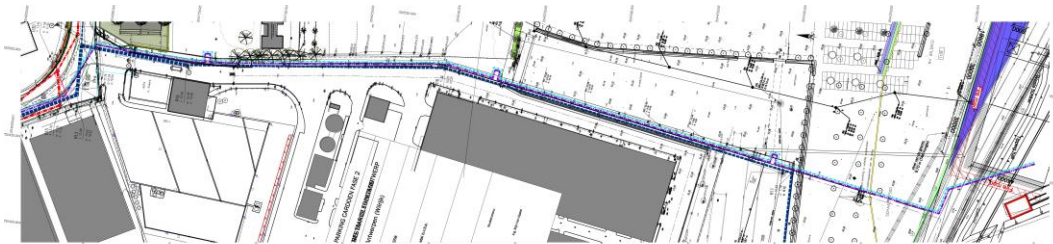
Plantekening van de riolering en het warmtenet in het plangebied (deel 1). Bron: opdrachtgever.
